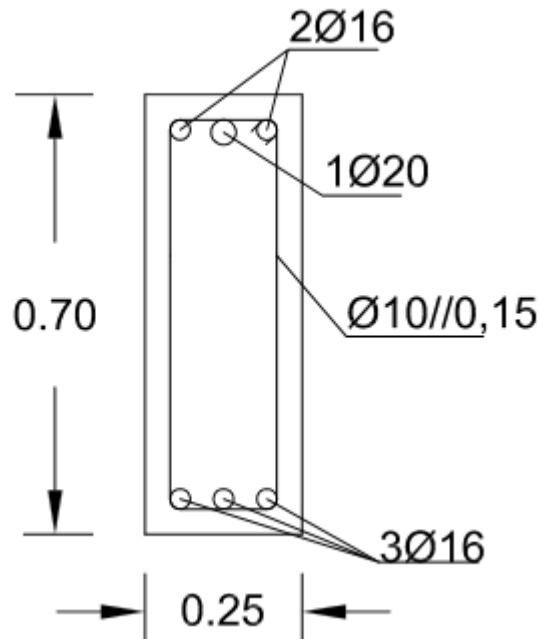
Armadura da viga com seção 25x70 m<sup>2</sup>
